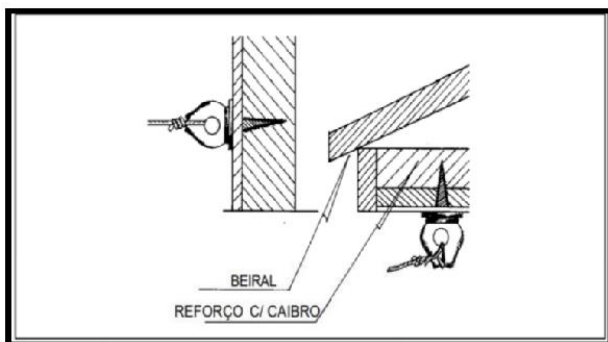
Fixação com isolador tipo olhal 85x65 mm em casa ou poste de madeira
